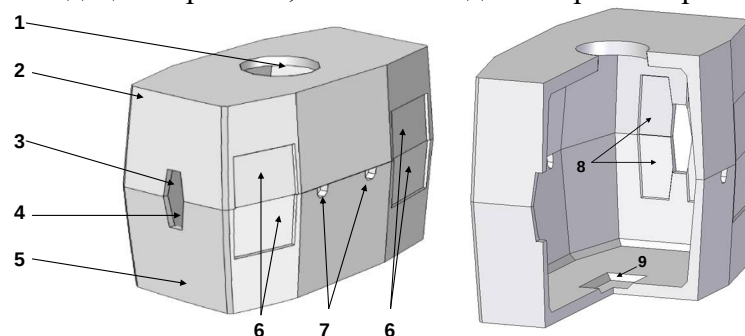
Колодец «ККСр-4-80», внешний вид и детали элементов колодца:
